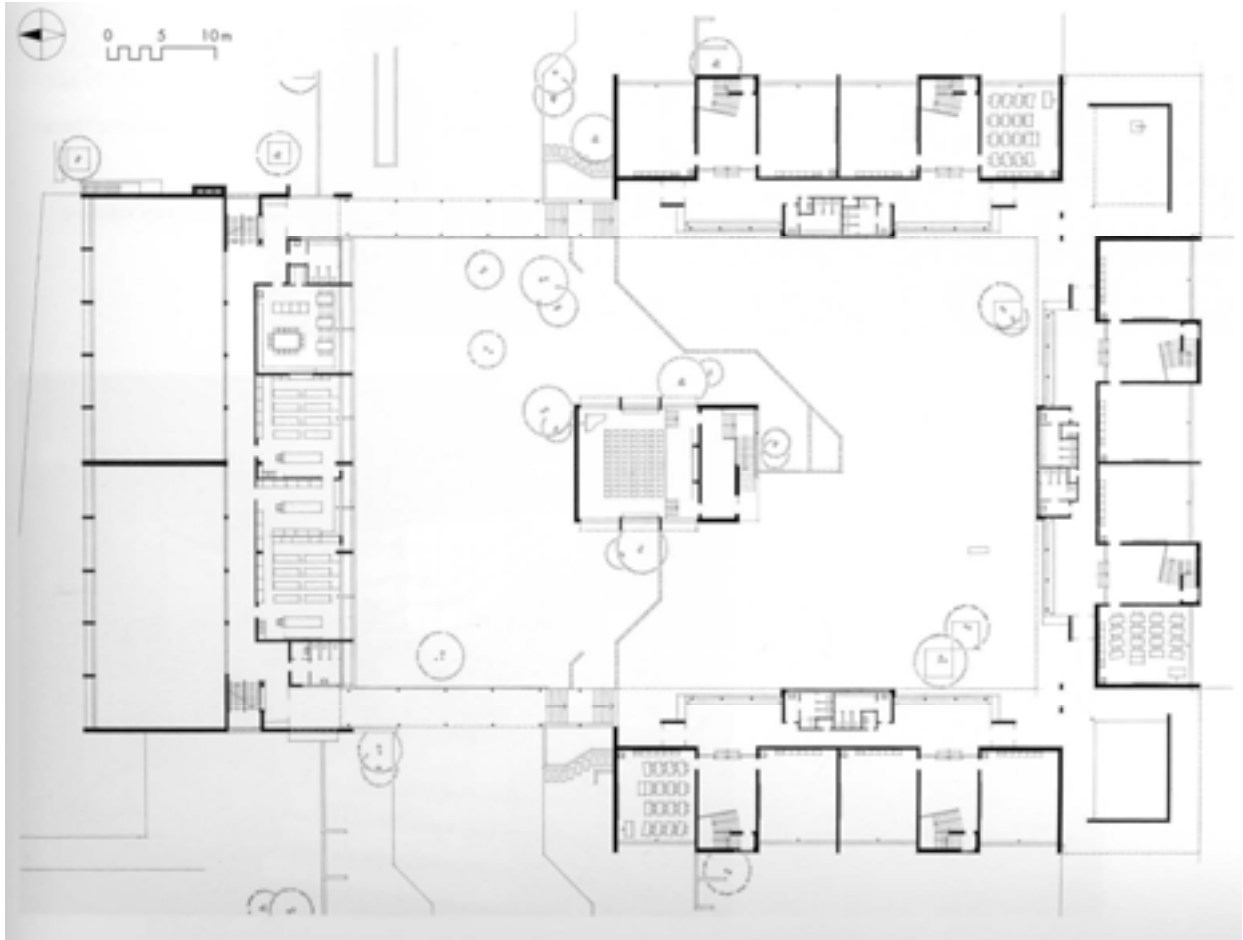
Ernst Gisel, Grundriss
